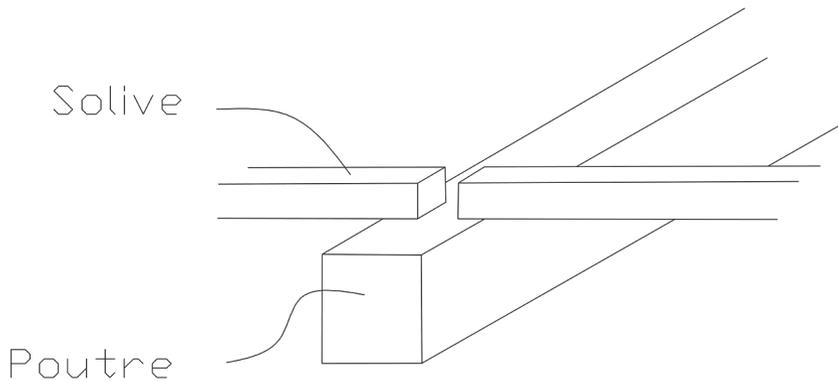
| Dispositions schématiques d'assemblage poutre/solives, dessin de l'auteur.
